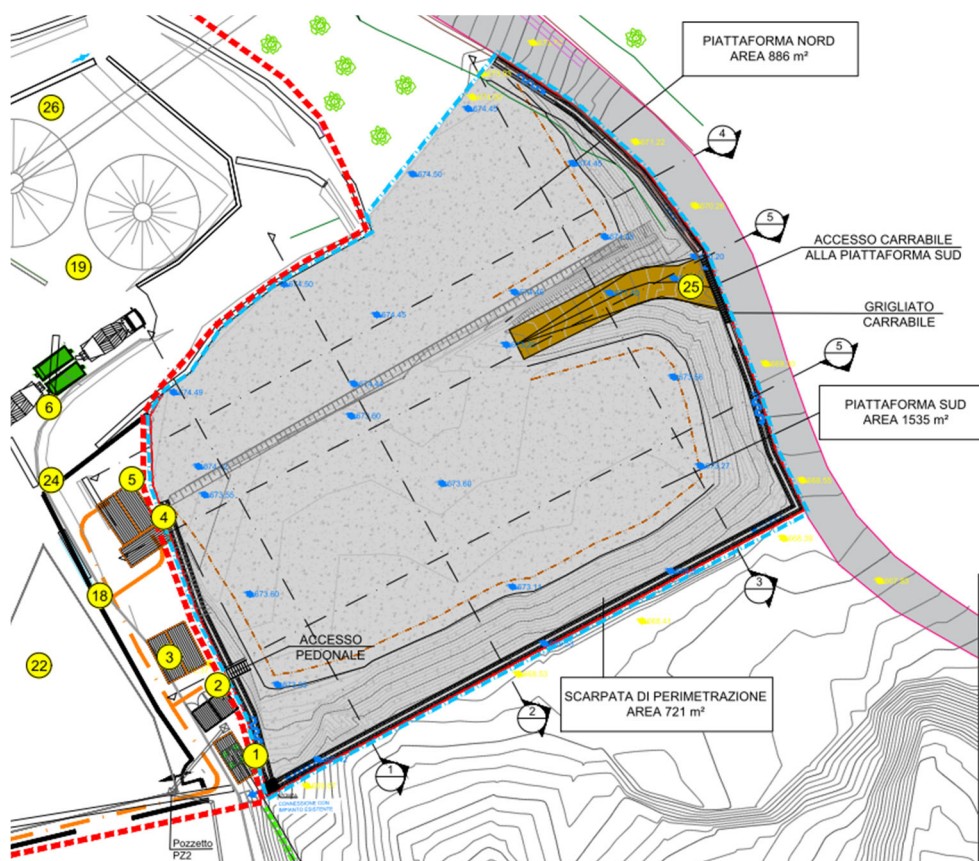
Estratto Planimetria dell'area di rimodellamento oggetto della variante
